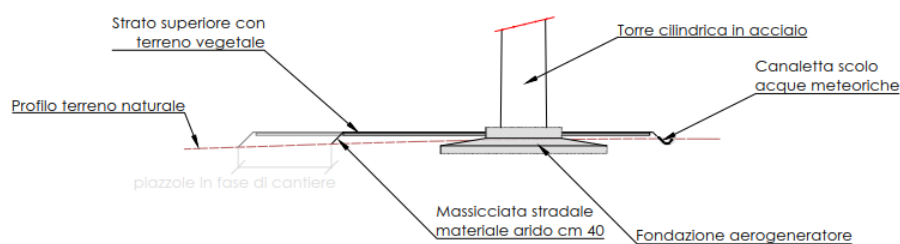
Planimetria tipologica ripristino aree piazzole
